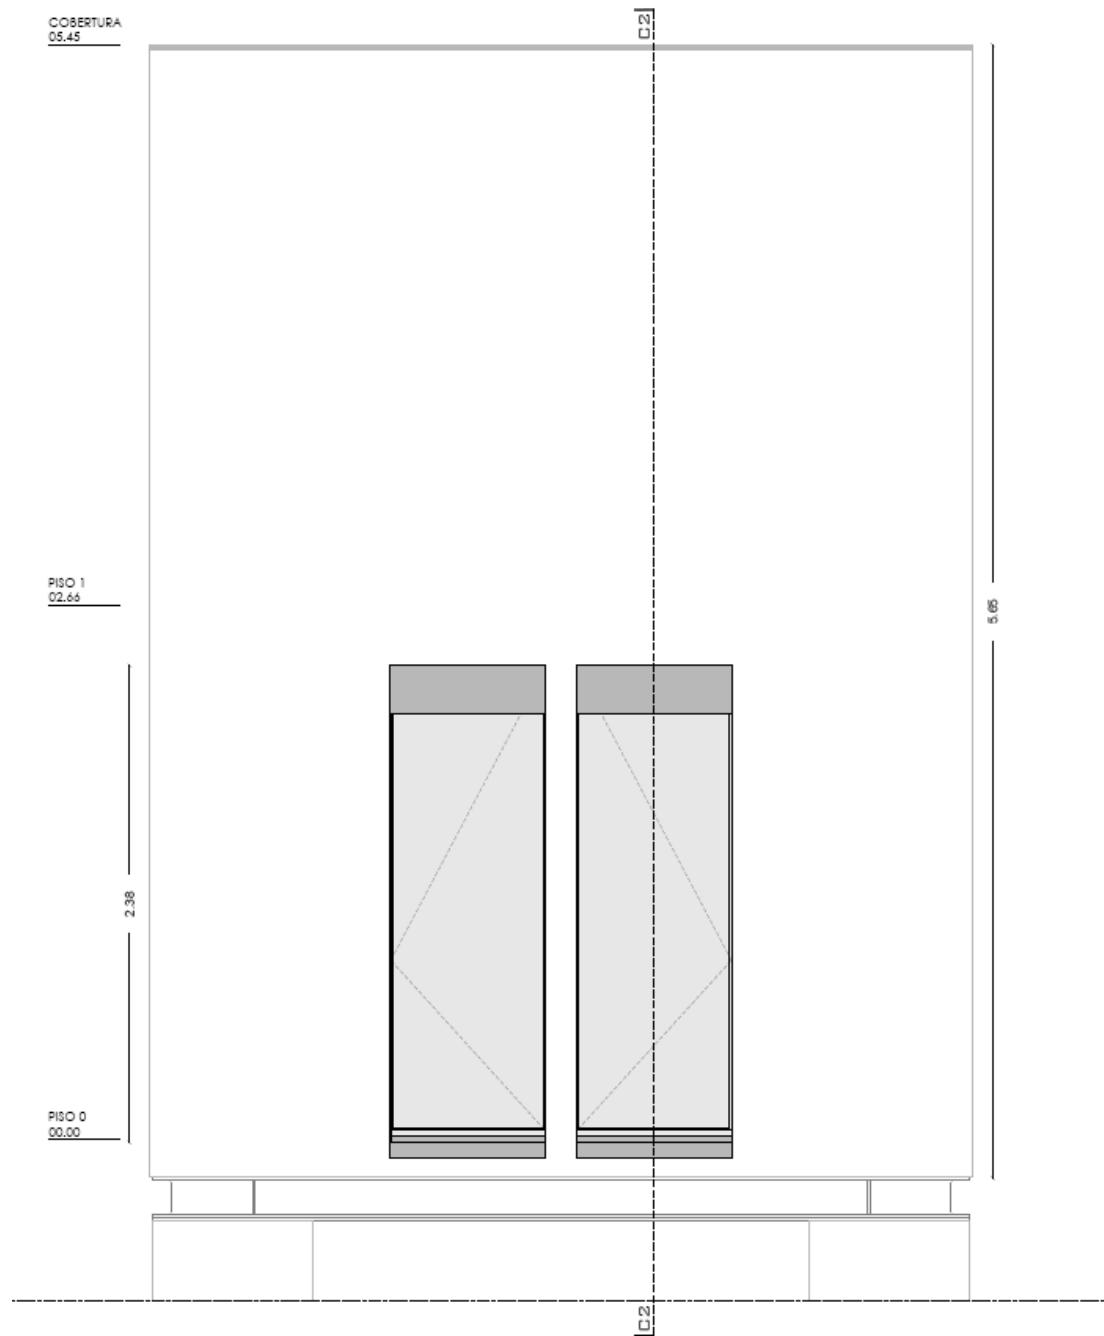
Alçado Lateral Esquerdo – “Construção Piloto”
